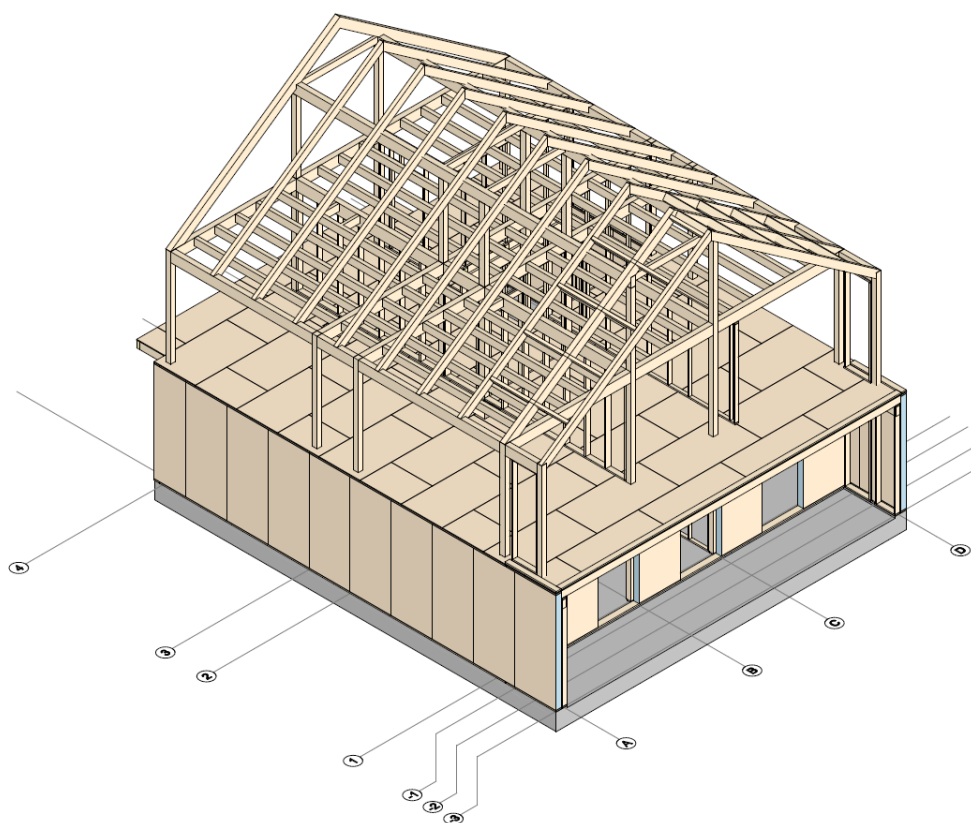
Estrutura da cobertura e revestimentos de OSB no pavimento e painéis SIP nas paredes do piso 0.
